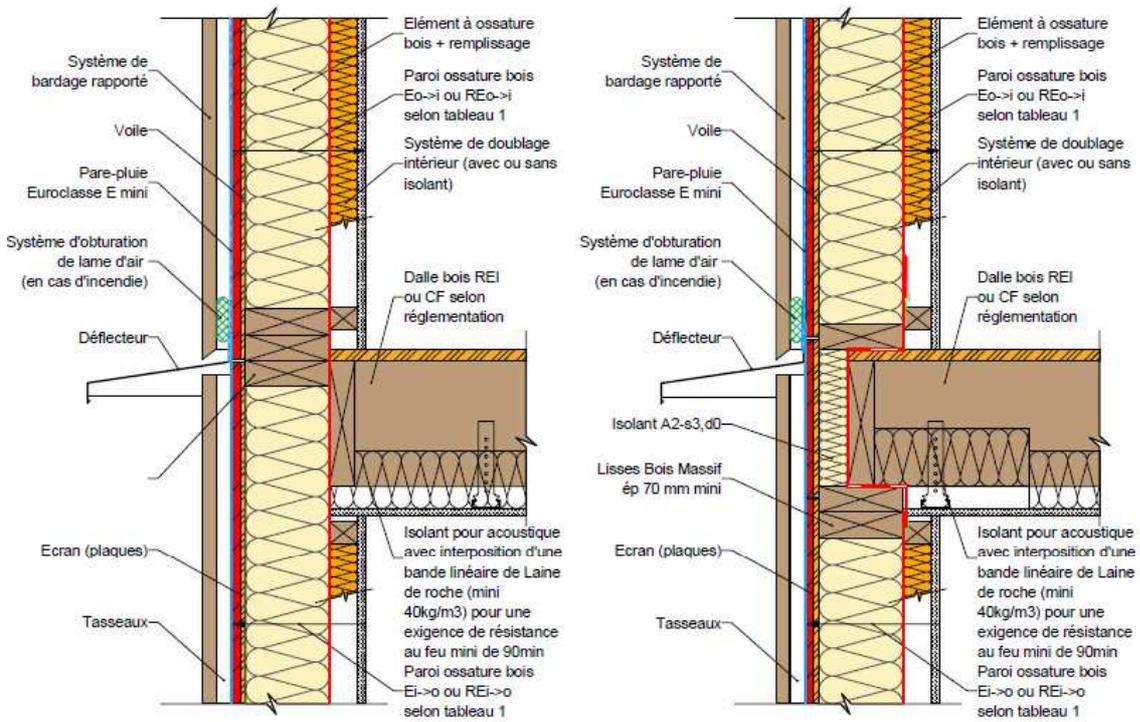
Façade/mur ossature bois & plancher en ossature bois.
